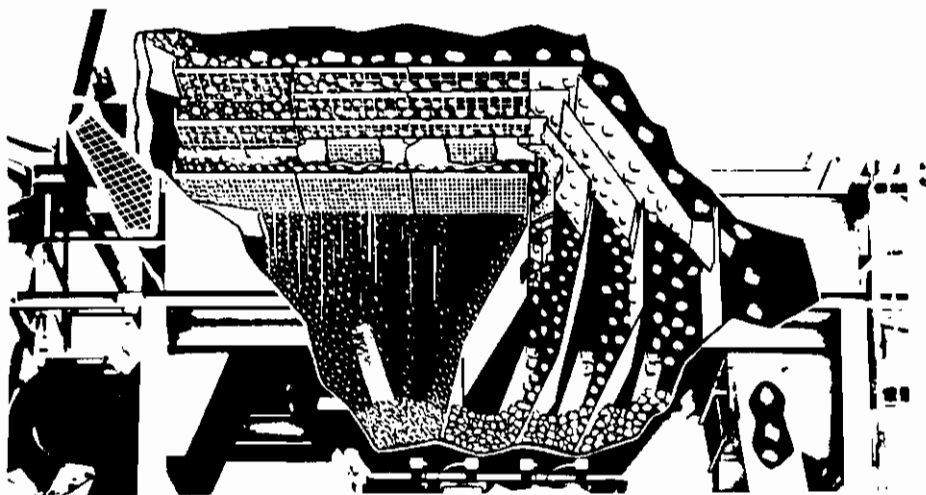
Vista Seccional com Pormenores do Fluxo de Material Através de Peneiras e Silos (Cortesia de Iowa Manufacturing Company)
